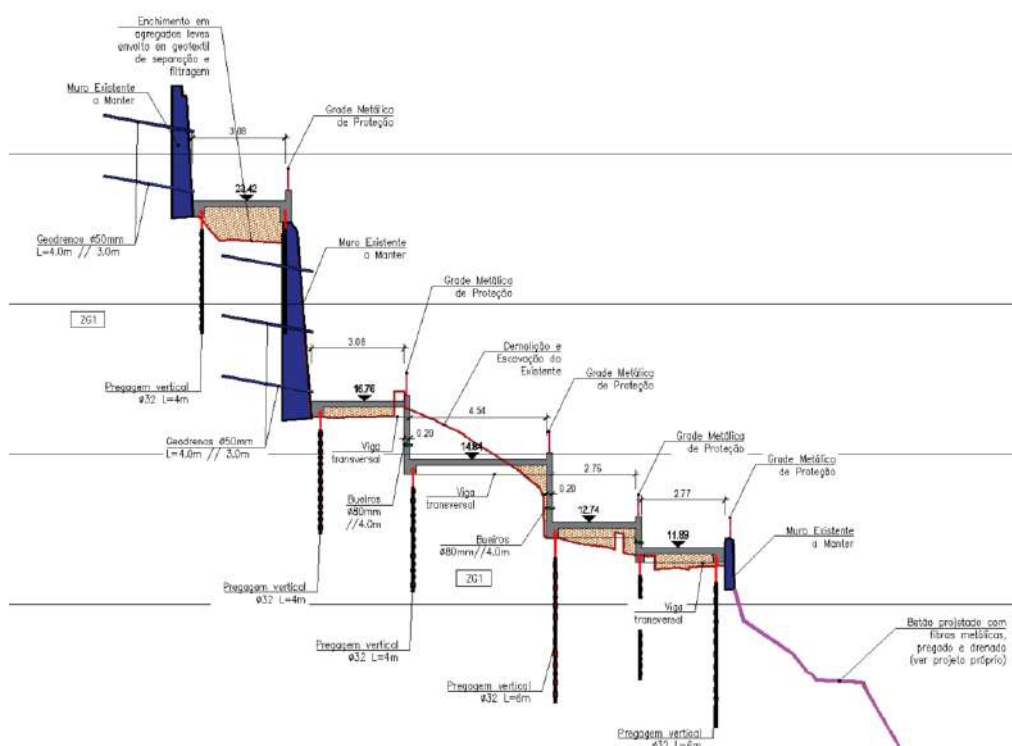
Reconstrução da escadaria – Secção transversal esquemática
